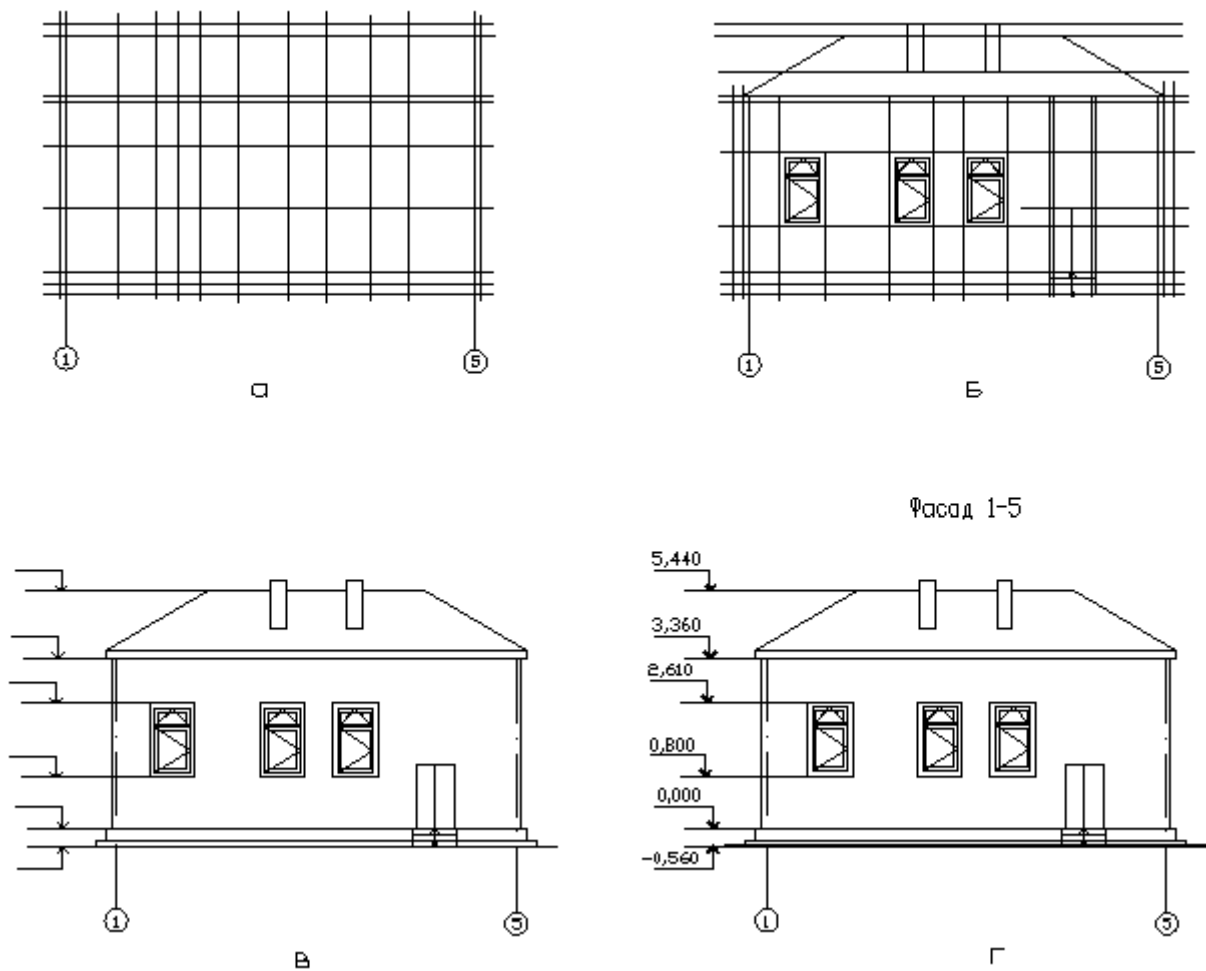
Послідовність виконання креслення фасаду будинку
